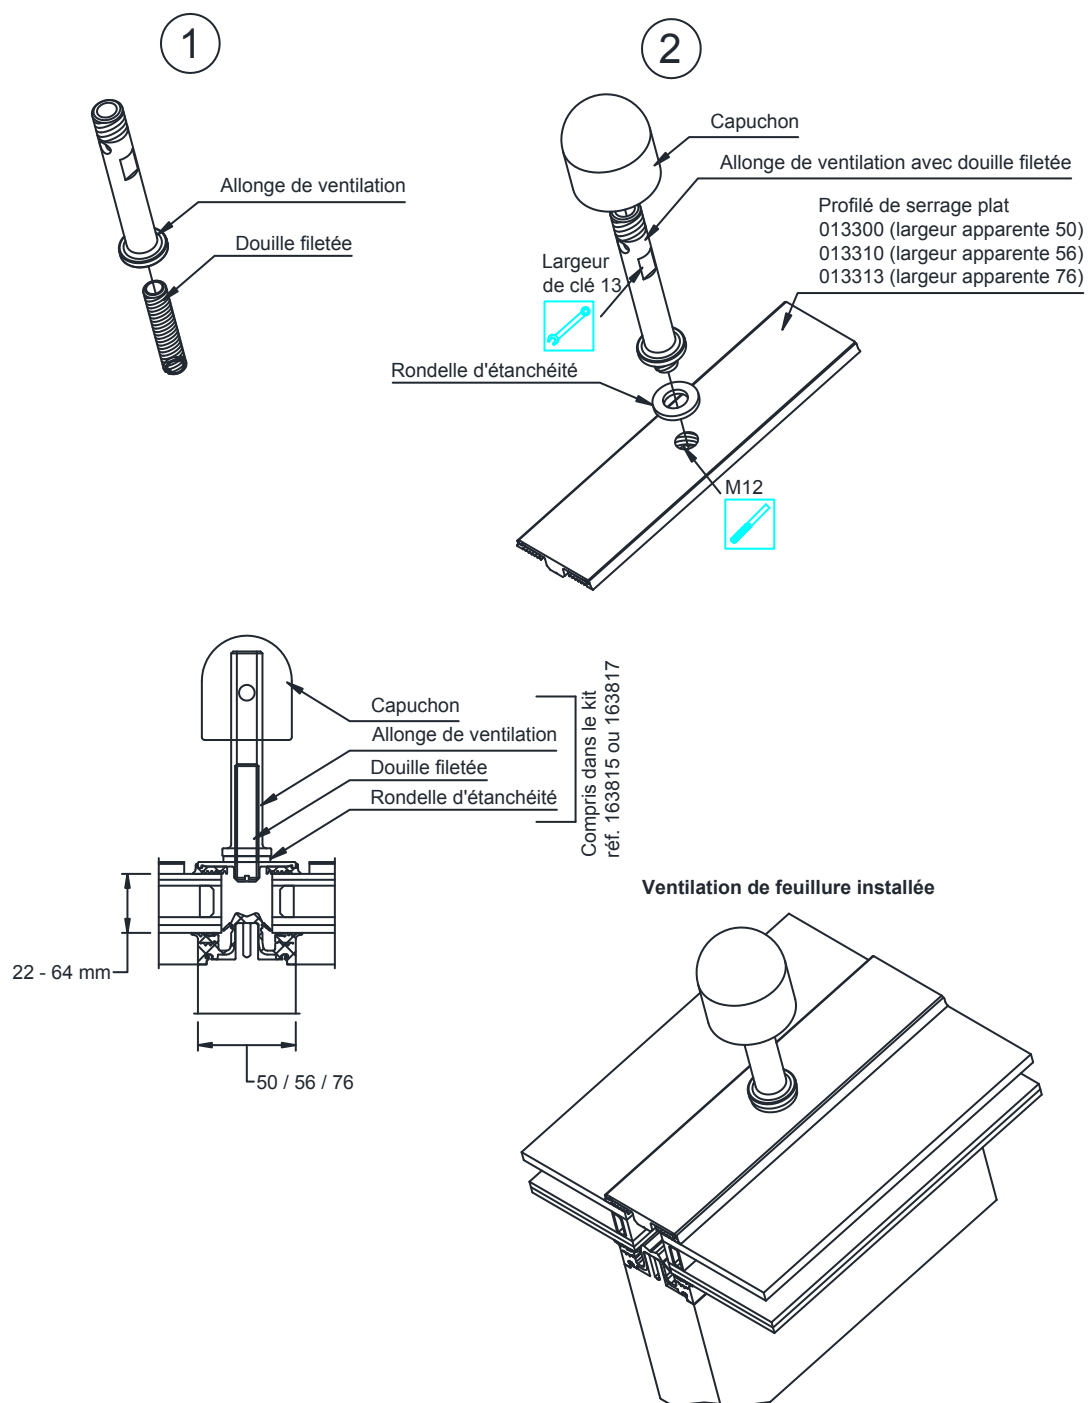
Montage ventilation de toiture dans un profilé de serrage plat
